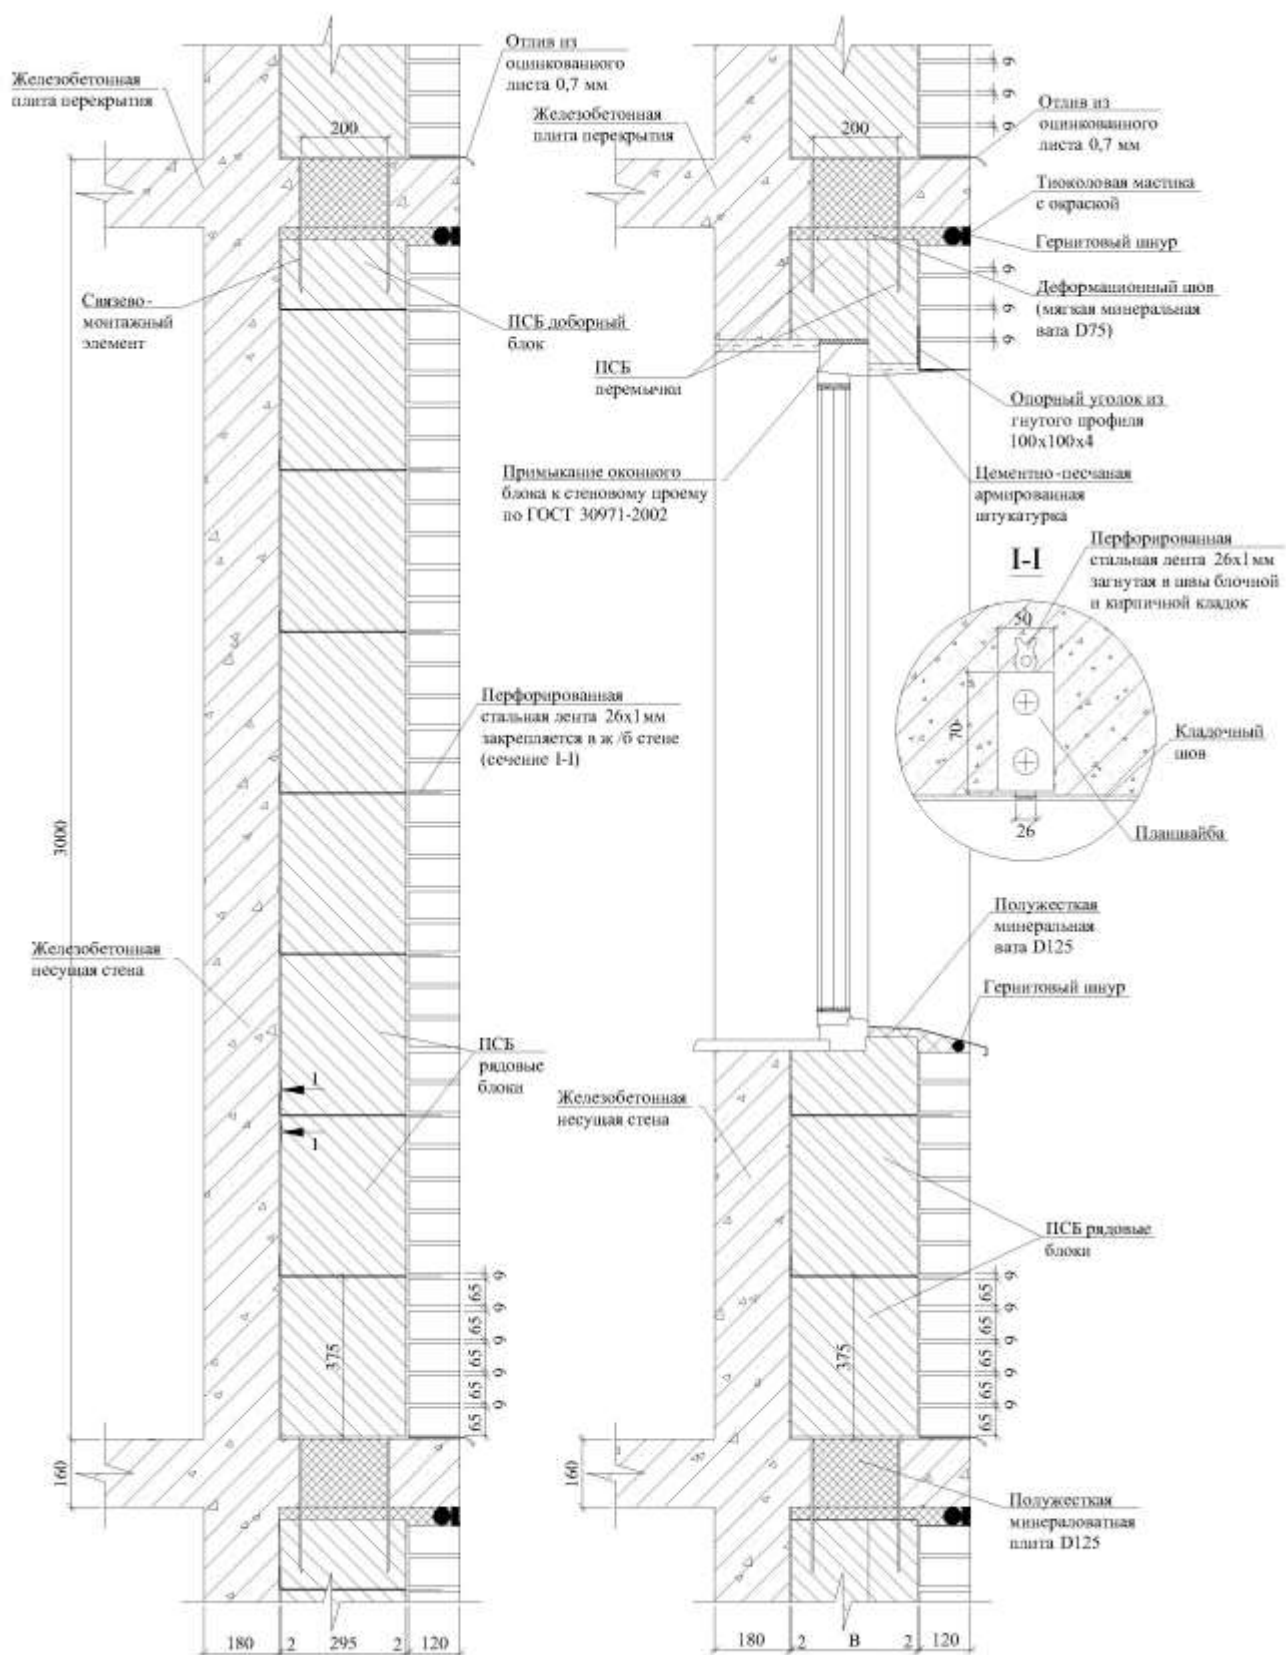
Несущая железобетонная стена с утеплением из ПСБ блоков и наружной кирпичной облицовкой толщиной в 0,5 кирпича
